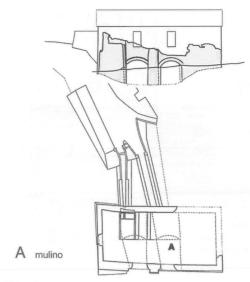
Mulino del Capitolo, Penne (Pe). Pianta e prospetto del rudere, con ricostruzione ipotetica della conformazione originaria (Cacciavillani, 2013).
